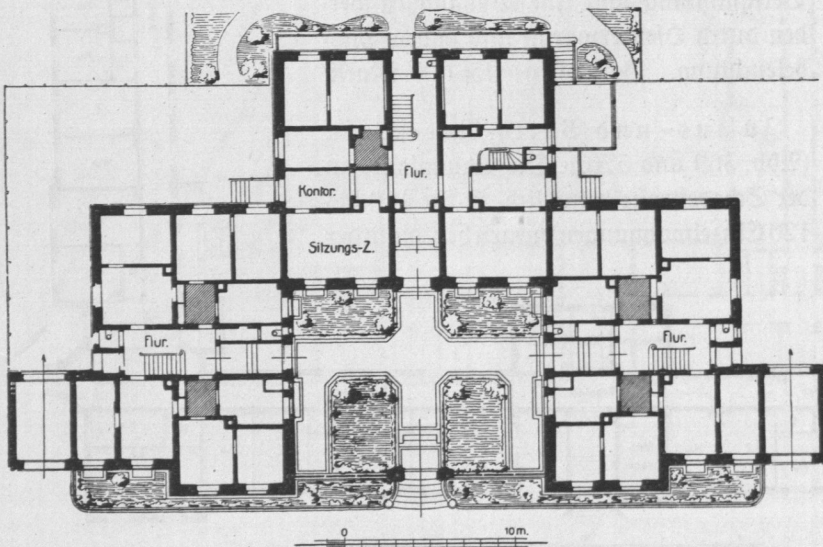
Heine-Anstl, Erdgeschoß, Grundriß.
